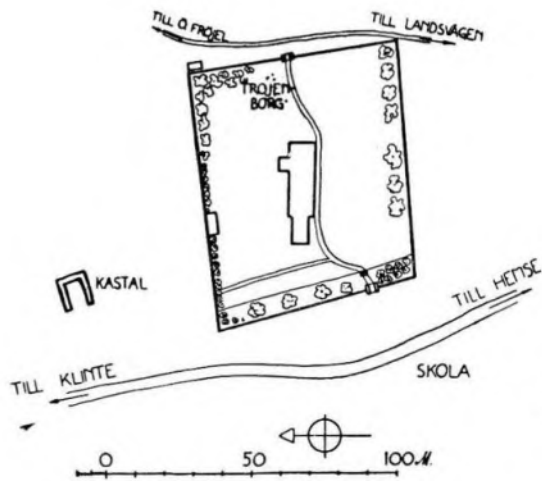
Situationsplan. Skala 1 : 3 000. Lageplan.
